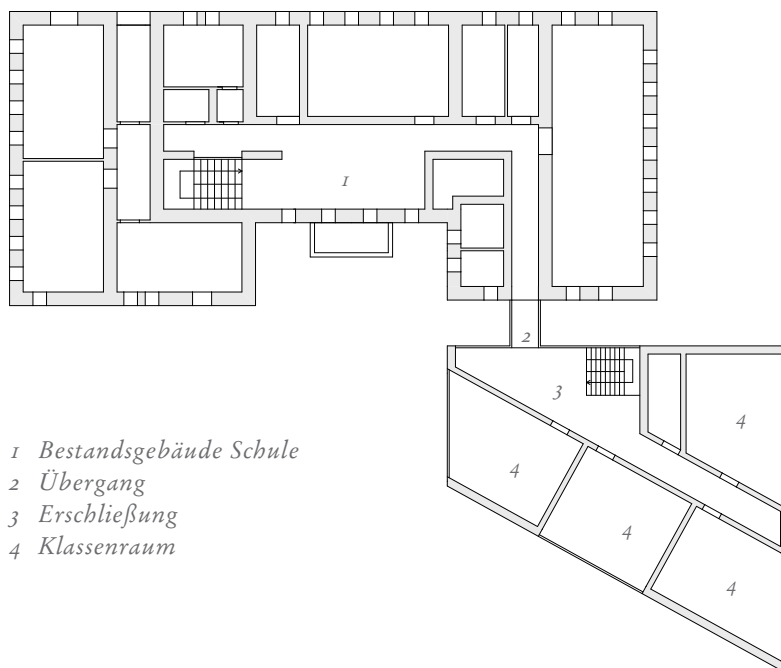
Grundriss Unterrichtsräume-Zubau Stammhaus
